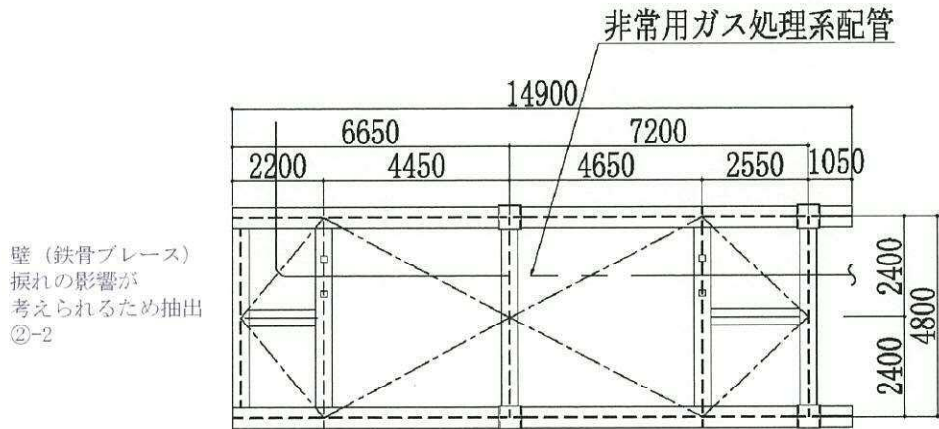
非常用ガス処理系配管支持架構の概略平面図 (EL. 20.8 m)
